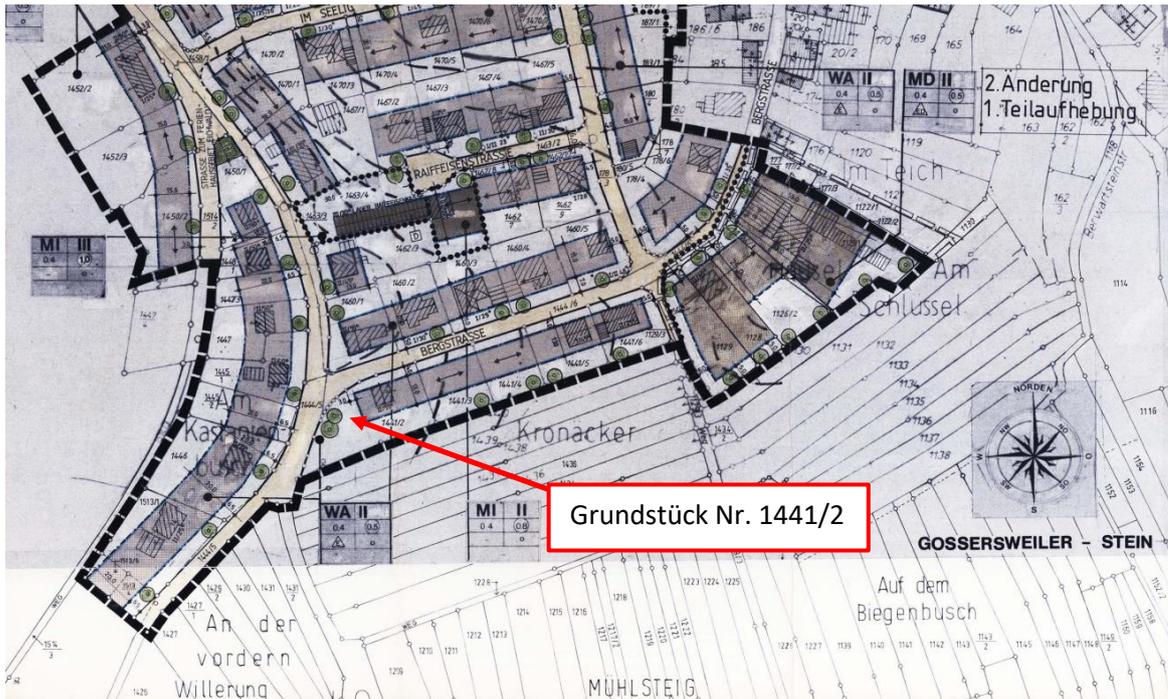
Auszug Bebauungsplan „Im Seelig, 2. Änderung“, ohne Maßstab
